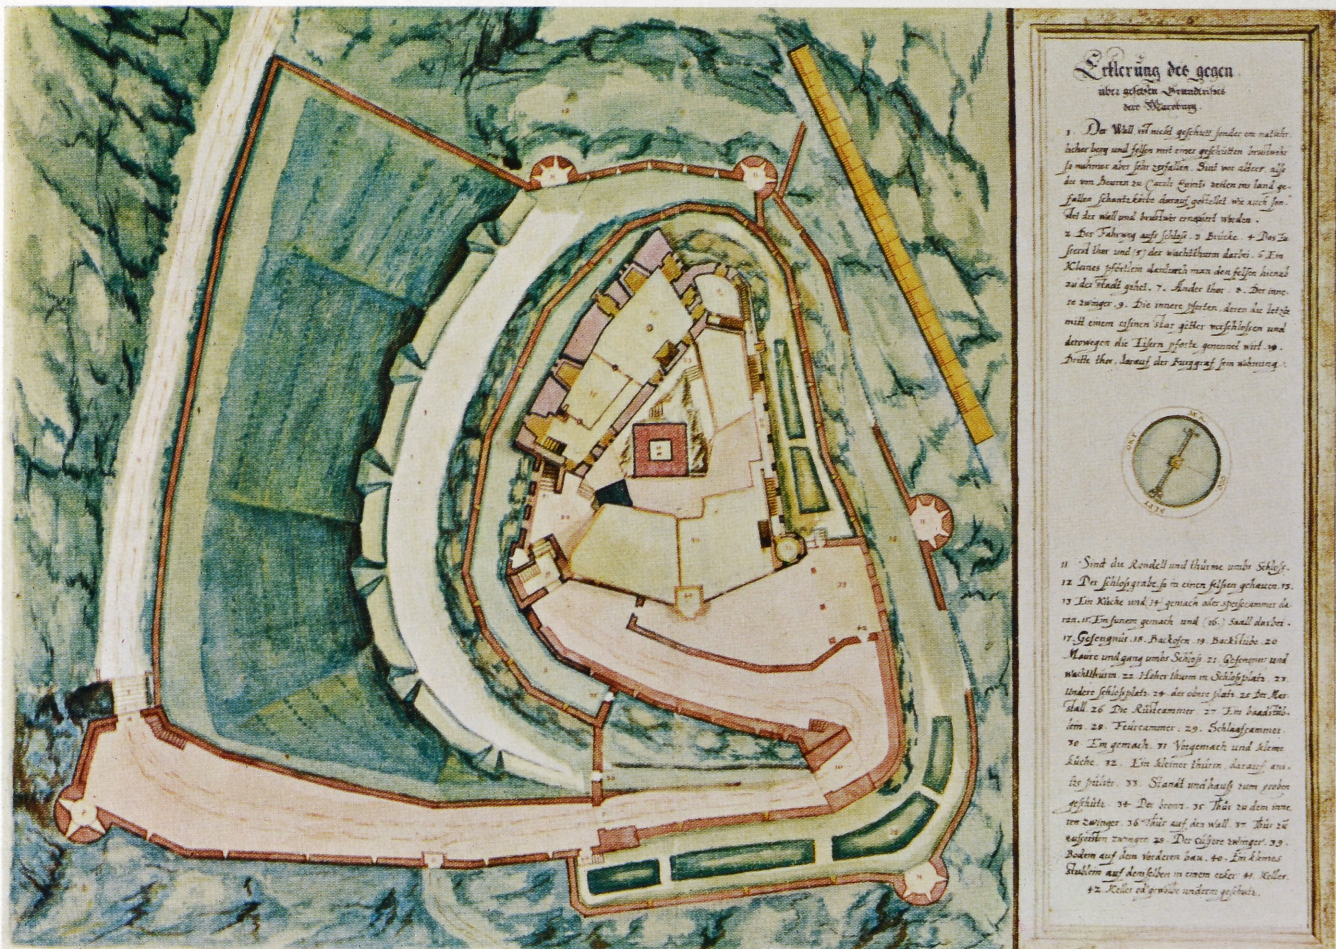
Grundriß der Marksburg. Originalzeichnung von Dilich 1610–15 mit Grundrissen der Gebäude
